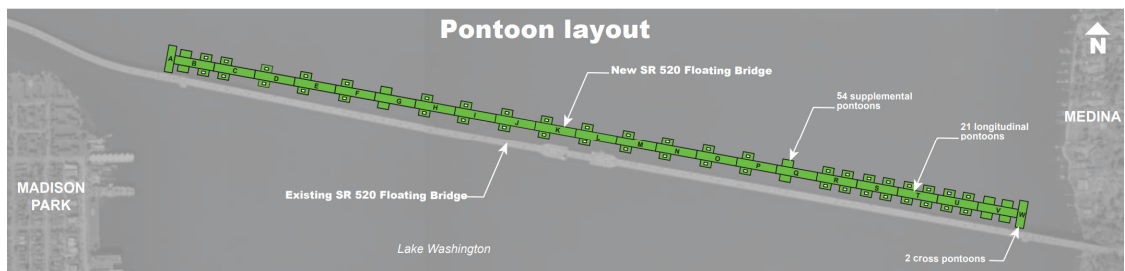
Grundriss Pontonanordnung (Washington State Department of Transportation, 2015)
